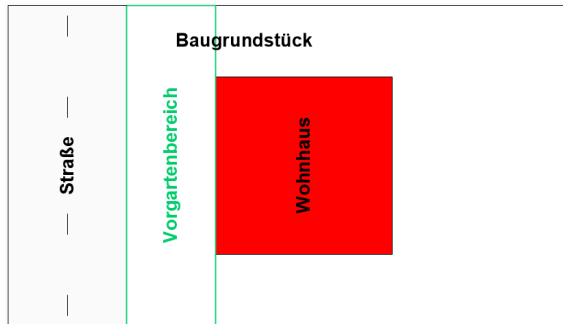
Veranschaulichung zur Lage des Vorgartenbereichs
